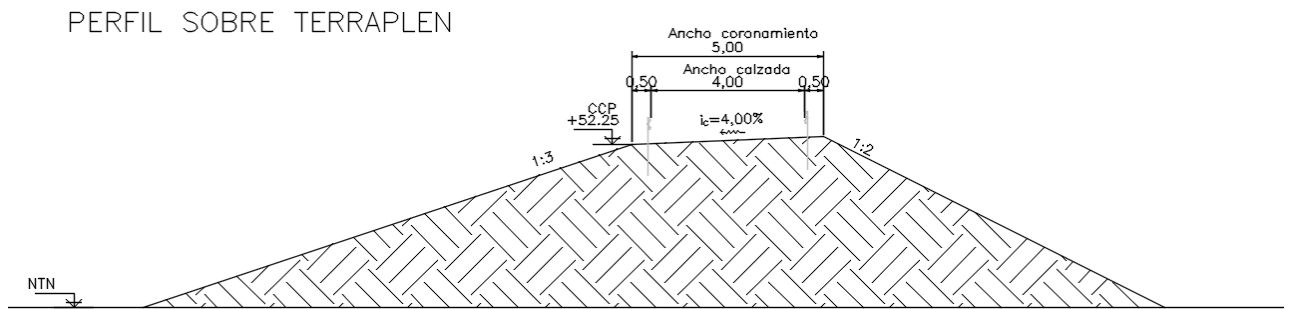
Perfil transversal sobre el terraplén. Fuente: Elaboración propia.
